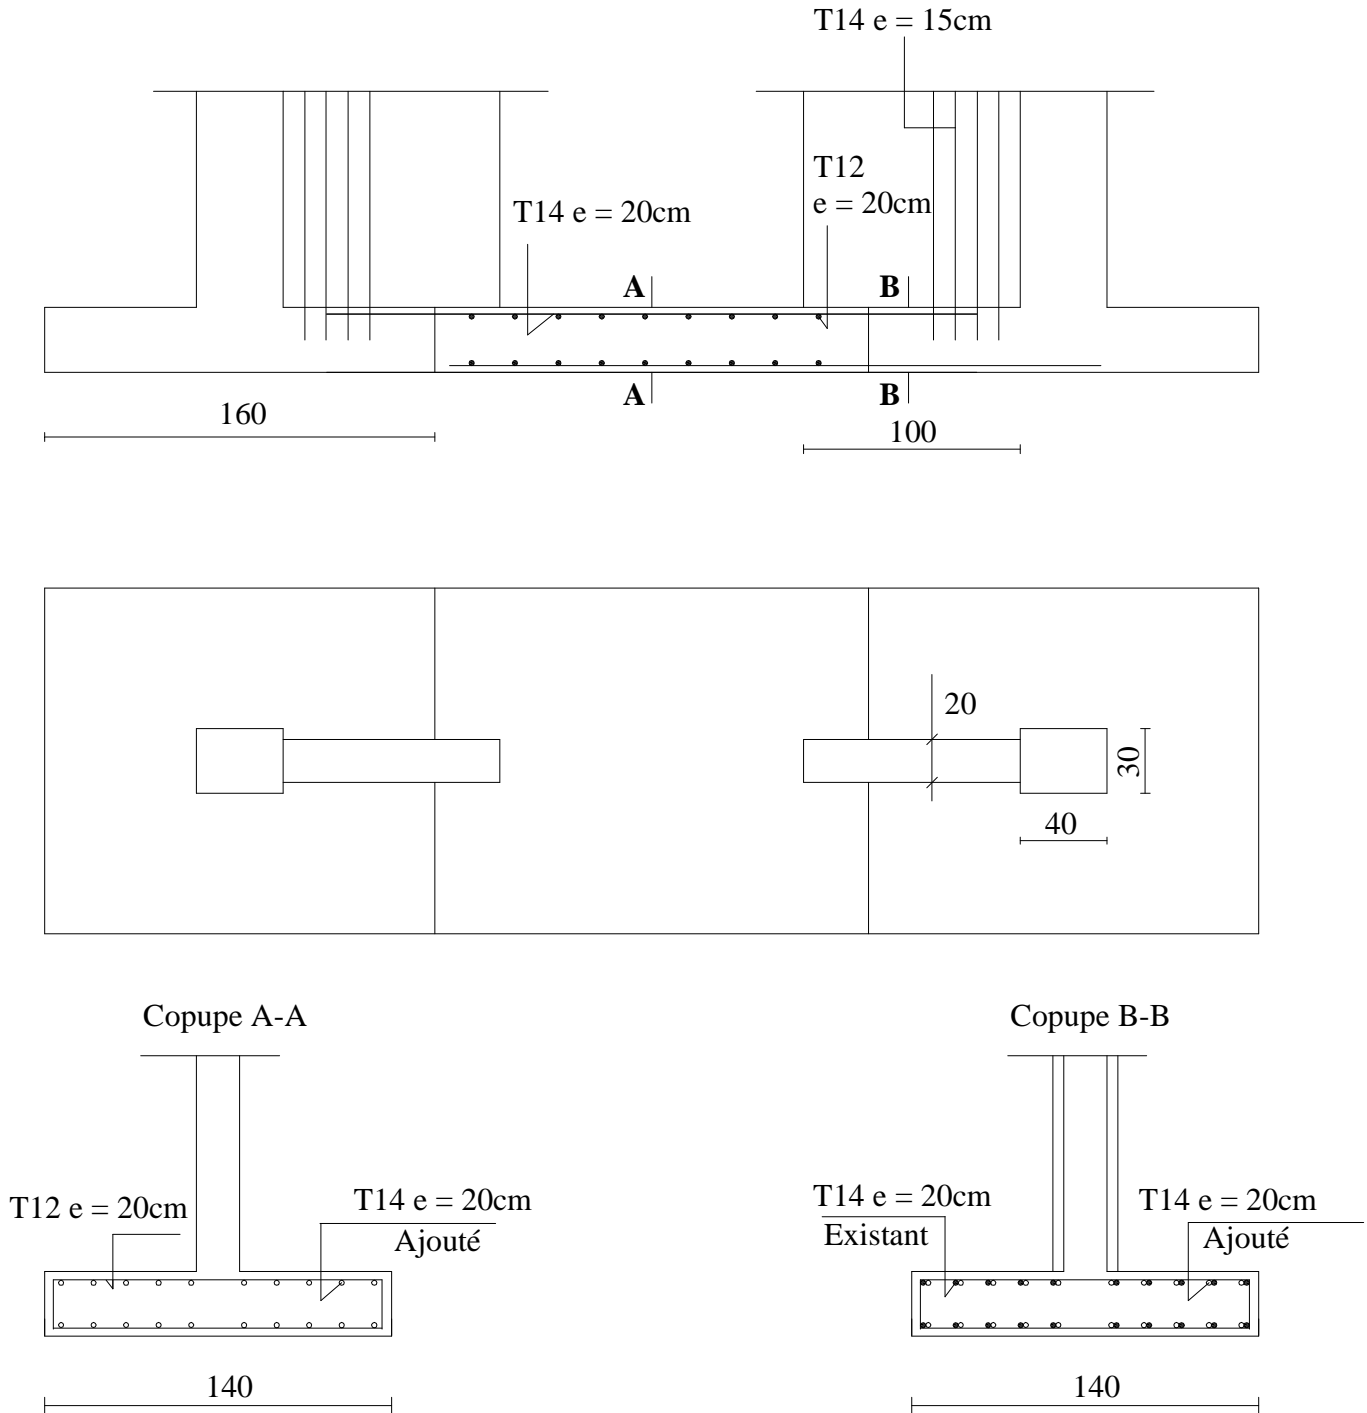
Ferrailage de la semelle sous poteaux existants et voiles de renforcement.
